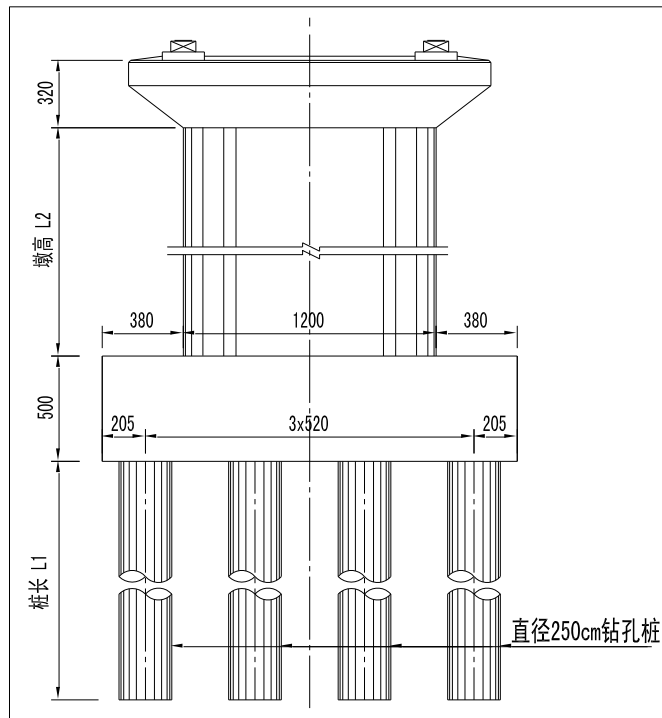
连续钢桁梁方案主墩立面图示意图（单位：cm）
